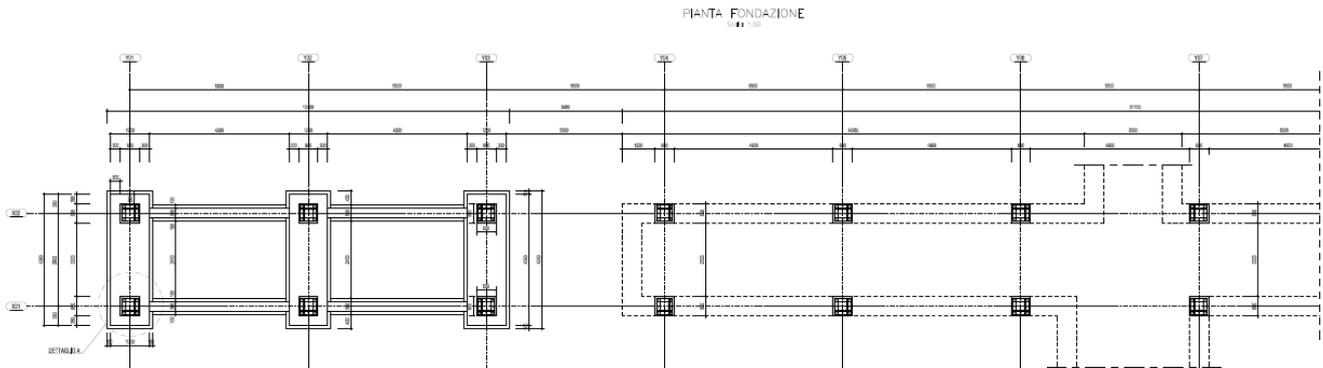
Pensiline – Stralcio Pianta fondazioni - Pensilina Sud
